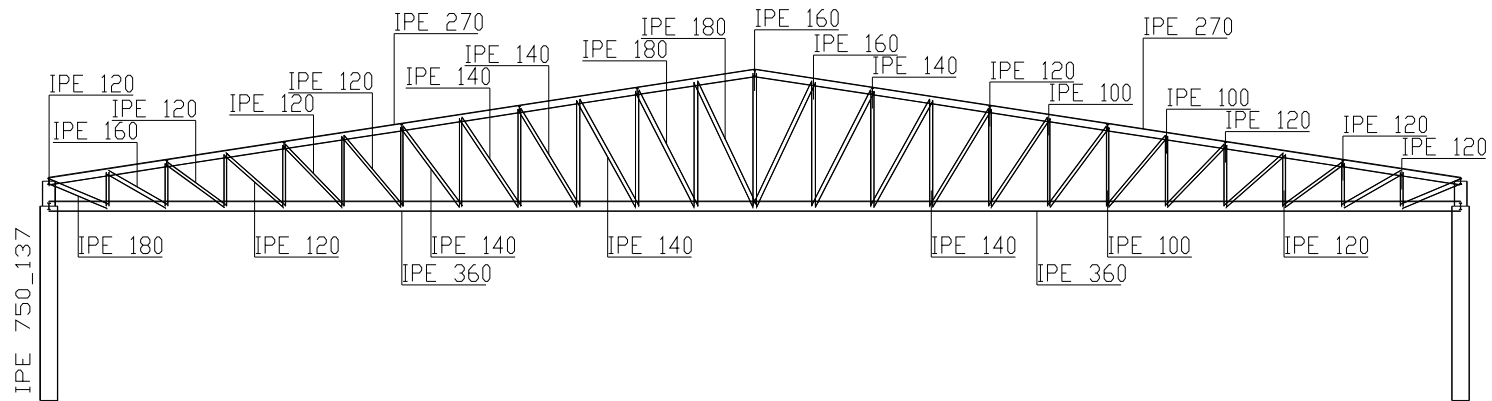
Pórtico com pilar de alma cheia, viga em treliça, vão de 60.00m, pilar e viga em perfil com secção transversal IPE.
